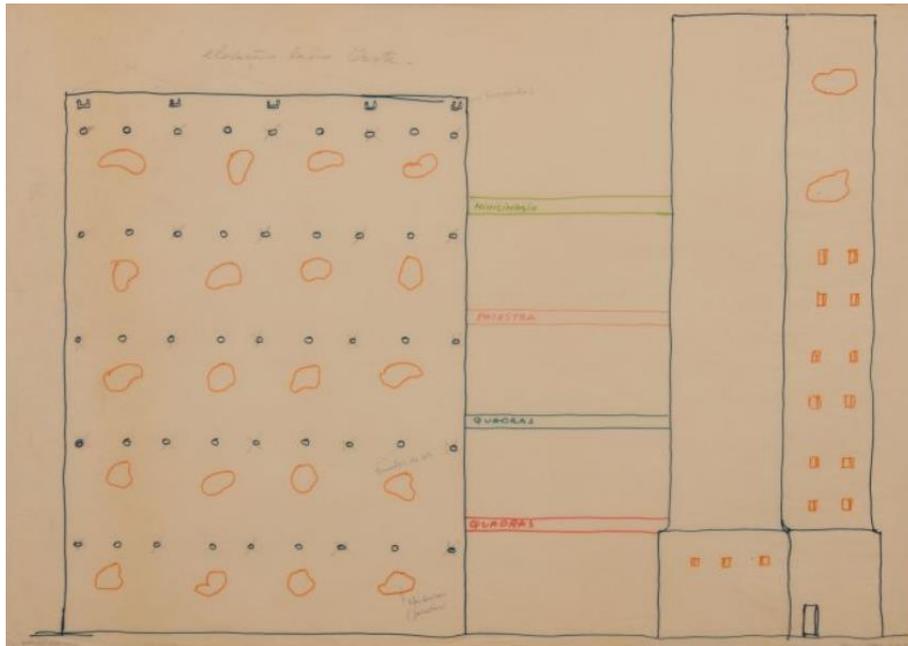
alzado de los bloques de hormigón de la SESC, Lina Bo Bardi, 1977, archivo Instituto Bardi
